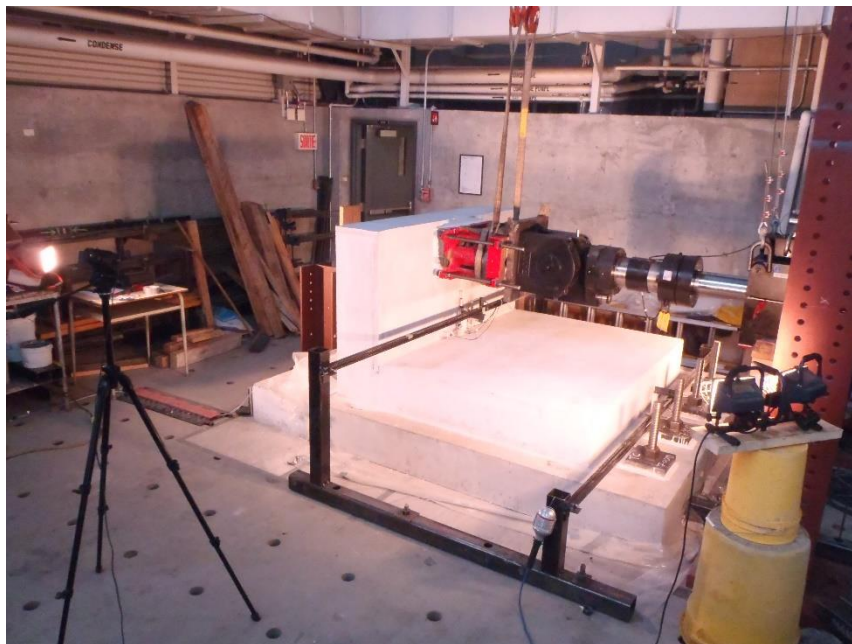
Cadres d'instrumentation installés sur le parapet pour l'essai mécanique
